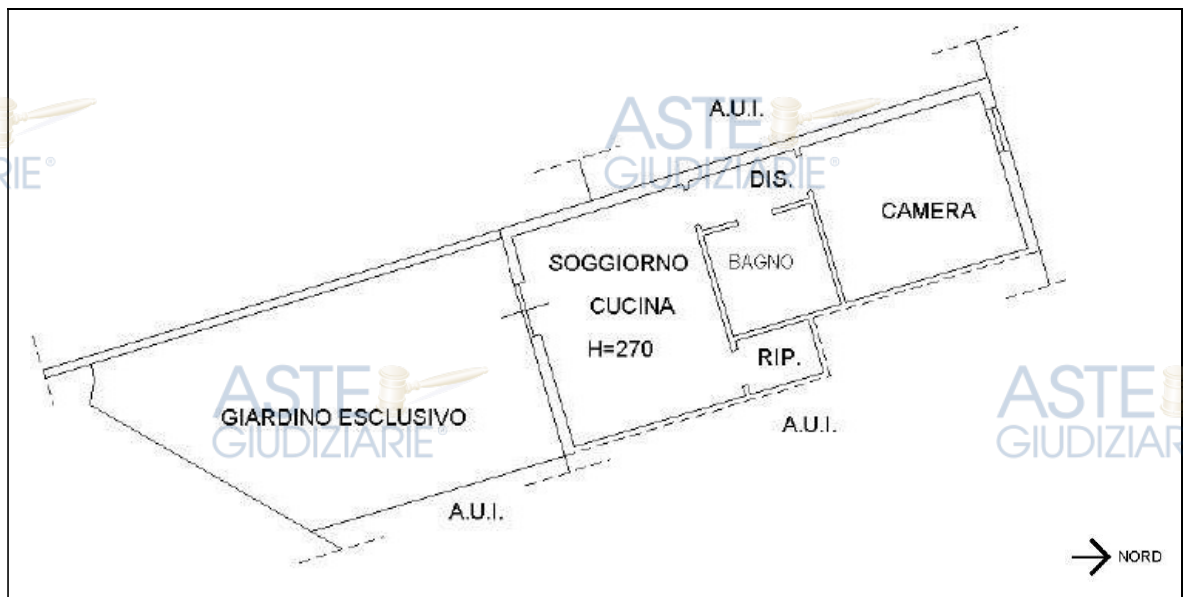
Estratto planimetria catastale Part. 169 sub. 1 -piano terra
